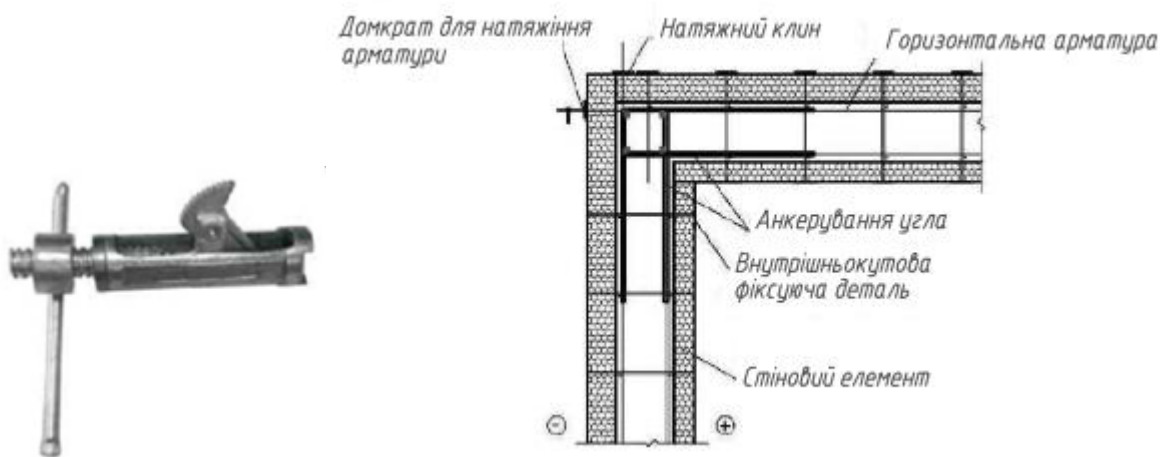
Натяг арматури стіни: а - ручний домкрат для натяжки арматури; б – спосіб натяжки кута стіни
